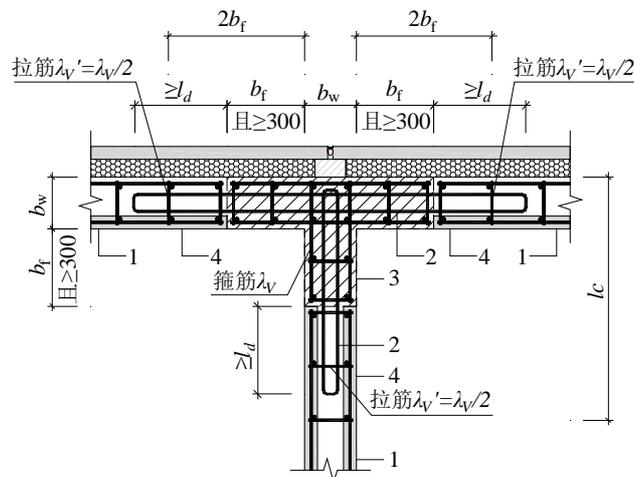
钢筋笼双板叠合墙与现浇剪力墙、约束边缘构件连接构造示意
